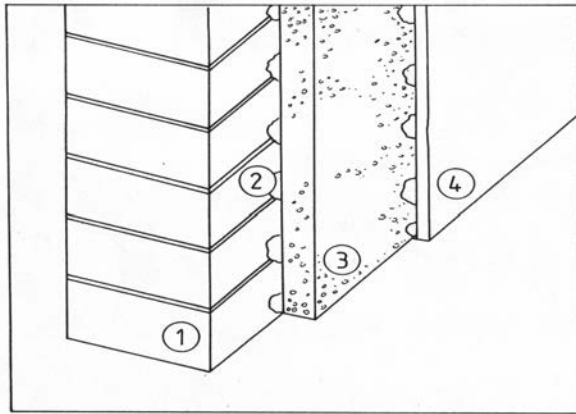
Aufbau einer holzverschalteten Dämmfassade
